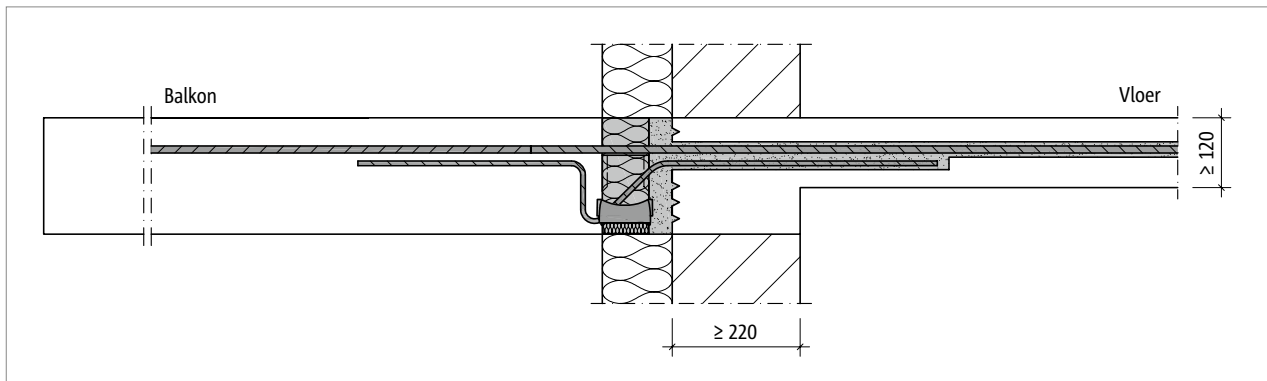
Schöck Isokorb® RT type SK: Barrièrevrije overgang door hoogteverschil
